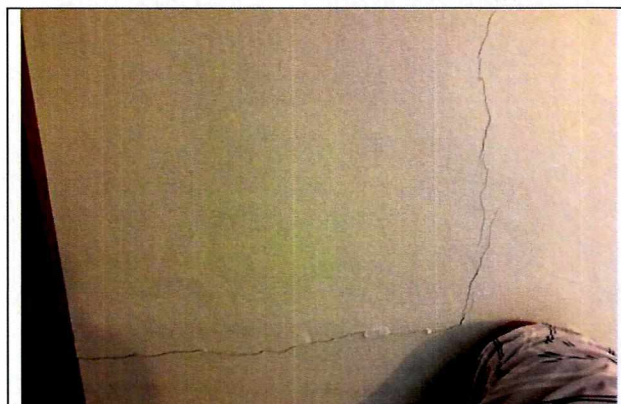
Fisura en muro interior – descanso de la escalera de acceso al segundo piso – 04 de febrero de 2019
